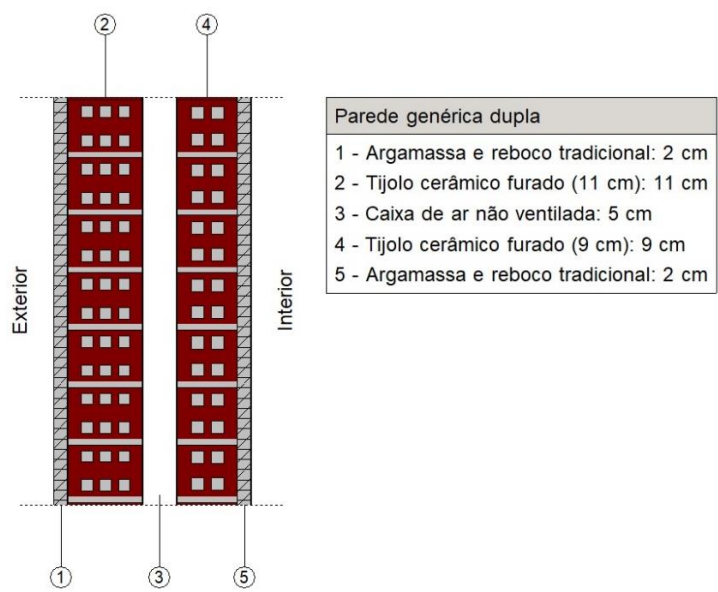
Pormenor construtivo da zona corrente, com a solução construtiva inicial
